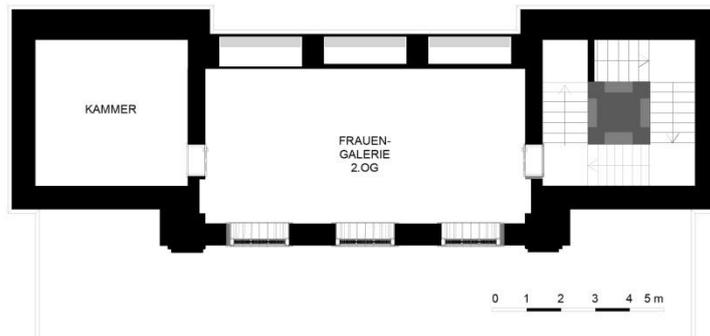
Grundriss 2. Obergeschoß (ARCHICAD)
